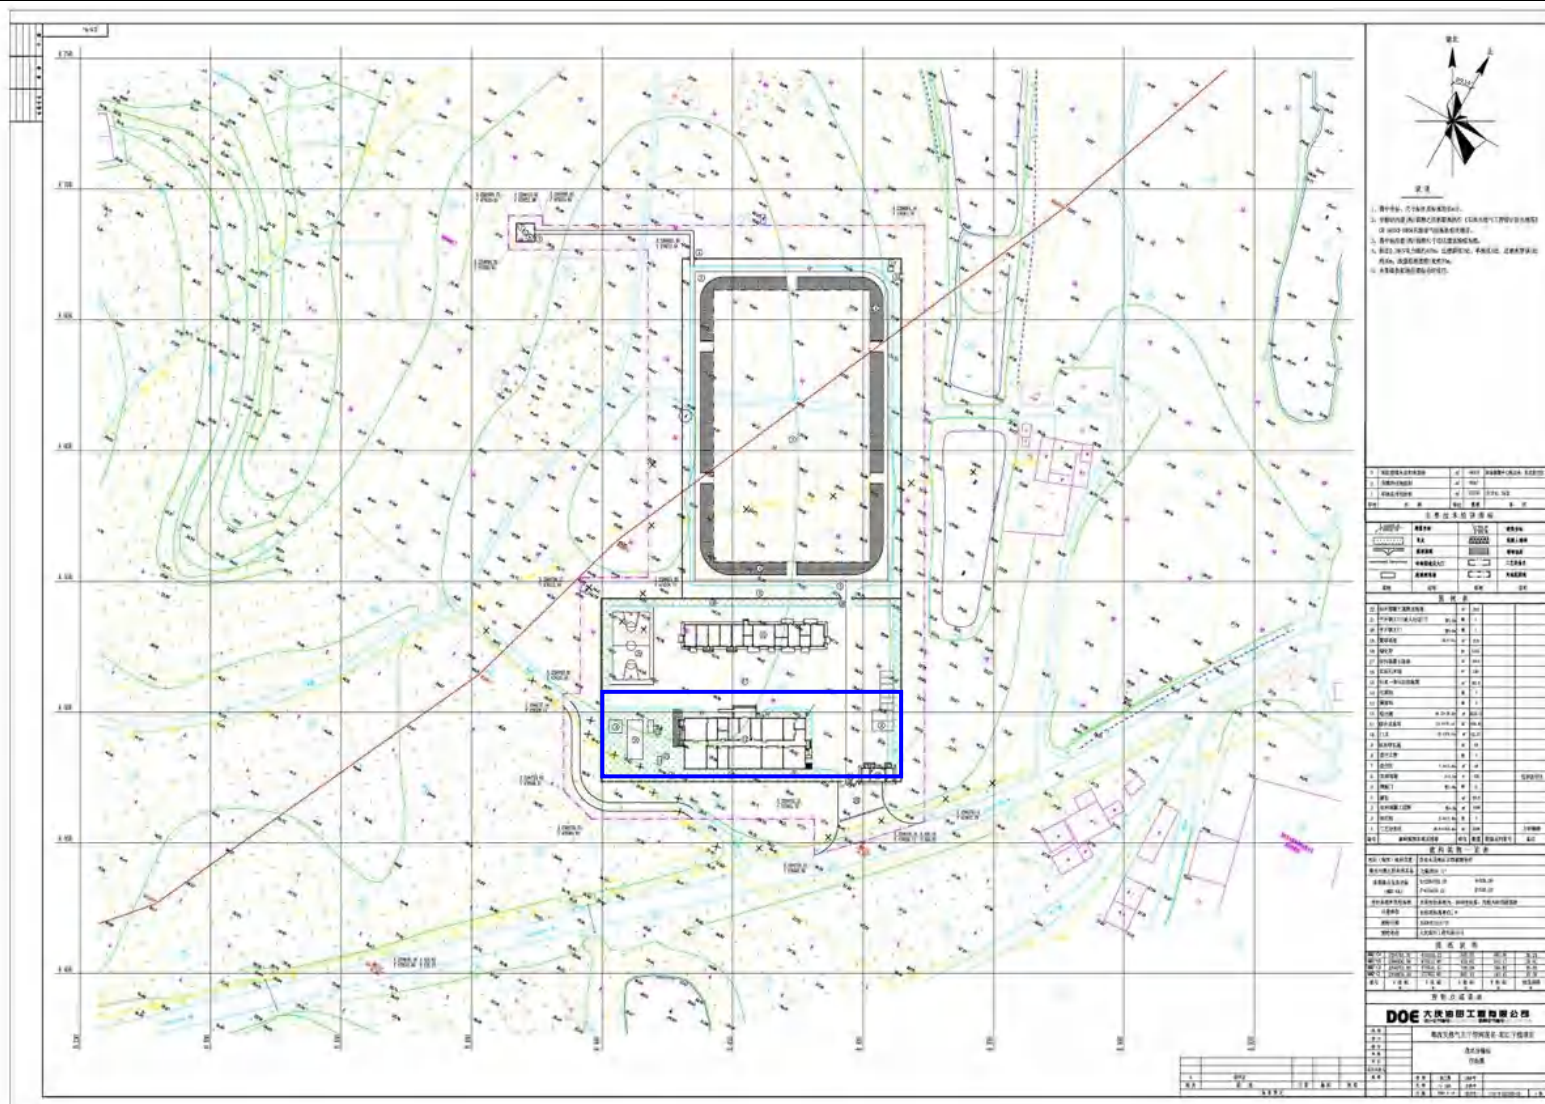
茂名分输站平面布置图 (蓝线为工艺区)
